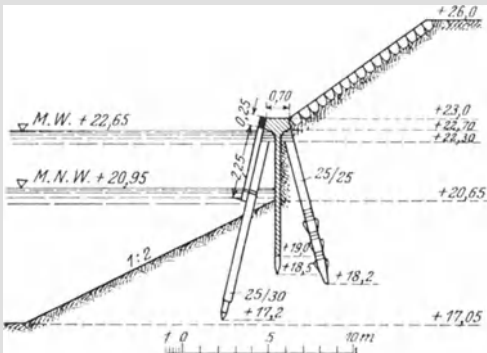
Bollwerk in Eisenbeton mit Bockunterstützung in Ruhrort. Maßstab 1 : 450.
